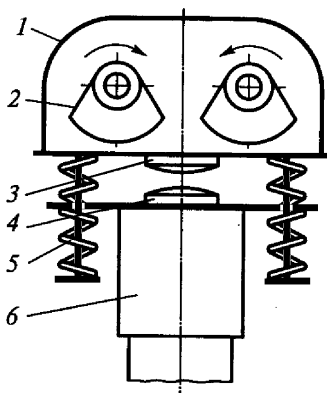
Схема вибромолота: 1 – вибровозбудитель; 2 – дебаланс; 3 – боек; 4 – наковальня; 5 – пружинный амортизатор; 6 – наголовник
